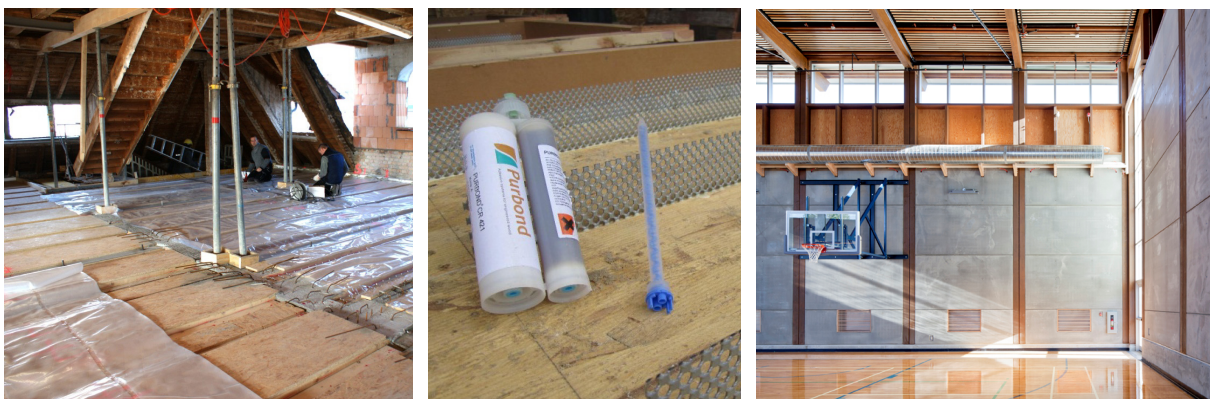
Holz- Beton- Verbundbauweise,
